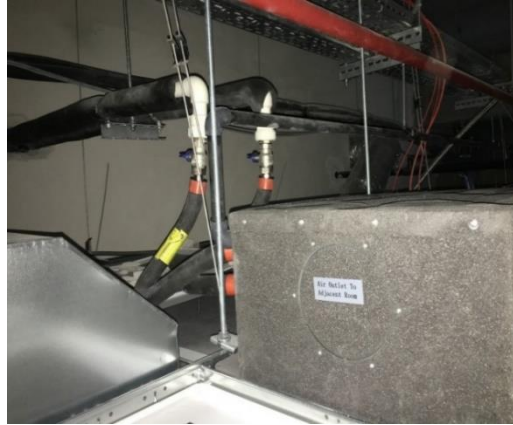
32 Toprak ve Beton hatlarının ısıtma-soğutma yapılacak mahallere taşınması ve tavan arası borulamanın görünümü
